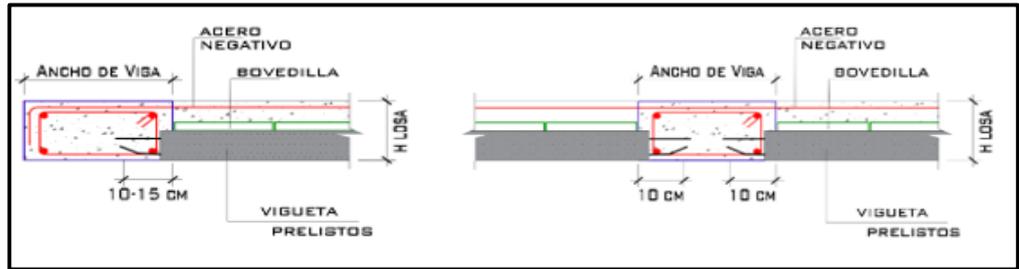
Detalle de ingreso de vigueta a viga chata con alambres vistos extremo discontinuo y apoyo continuo menores a 4.40 m.
